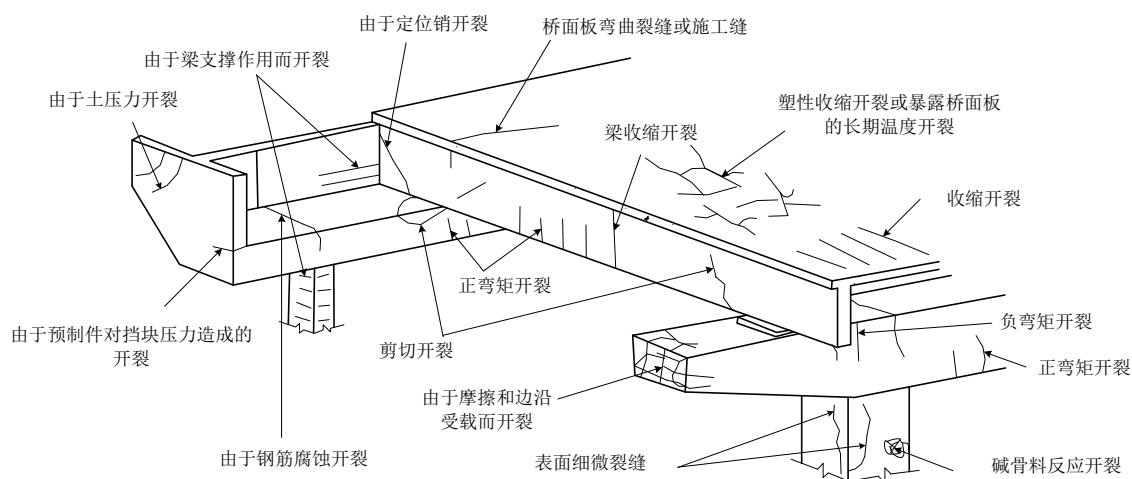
钢筋混凝土桥梁的各种常见裂缝
